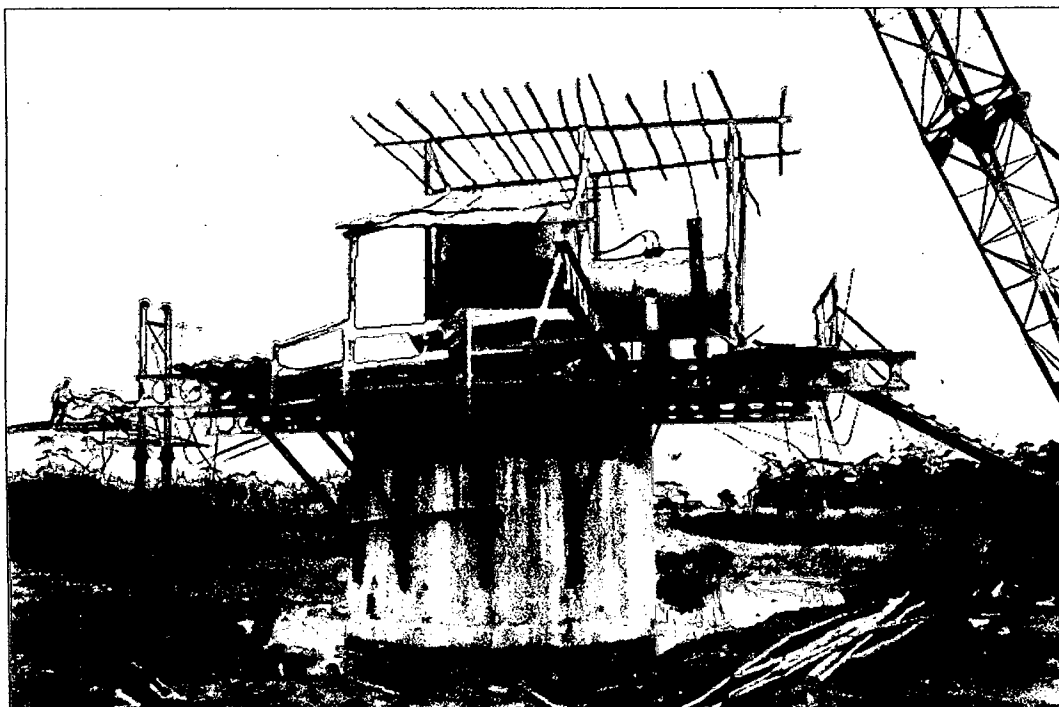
Montaje de la campana neumática en el estribo izquierdo.
